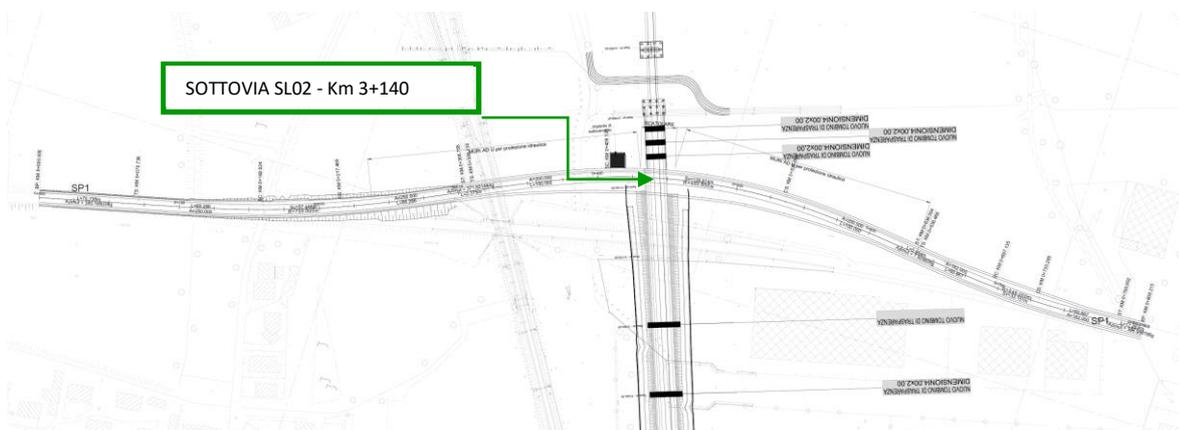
Ubicazione dell'intervento - Stralcio planimetrico
